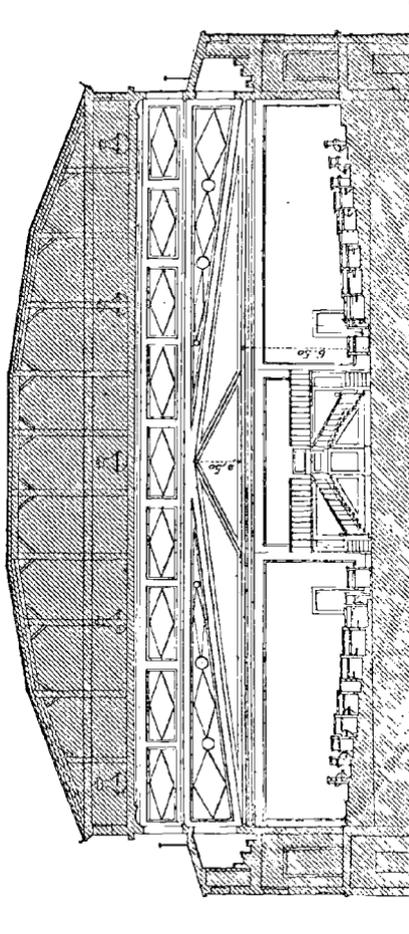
Coupe parallèle à la ligne A B du plan.
